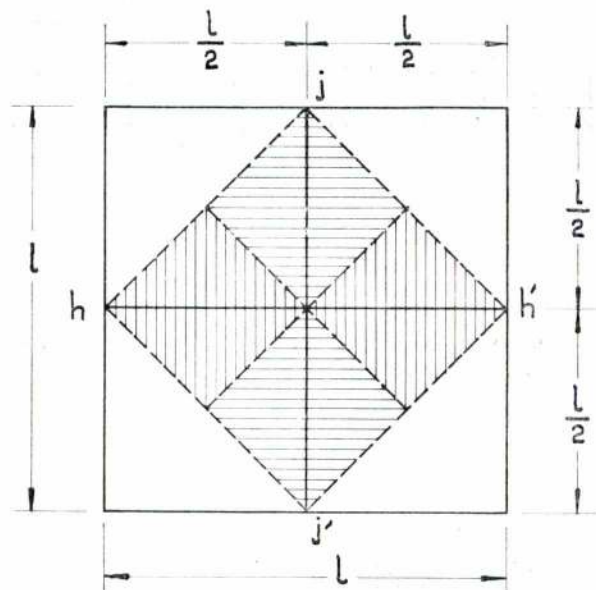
Estrutura simétrica, constituída por duas vigas cruzadas de igual vão, que sustentam uma laje de betão armado
